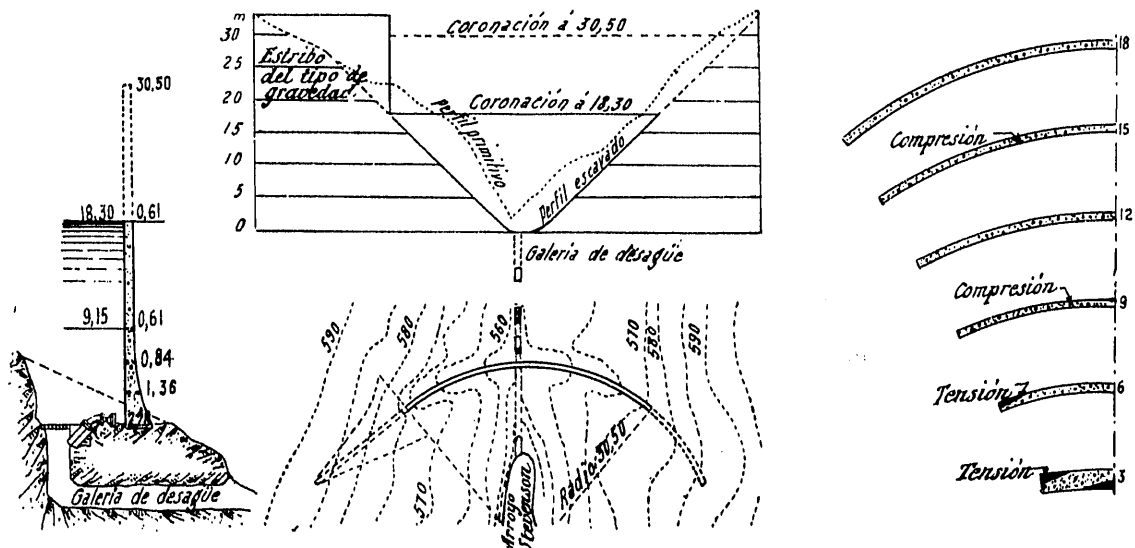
ª Planta, alzado y cortes de la presa de experimentación sobre el arroyo Stevenson.
